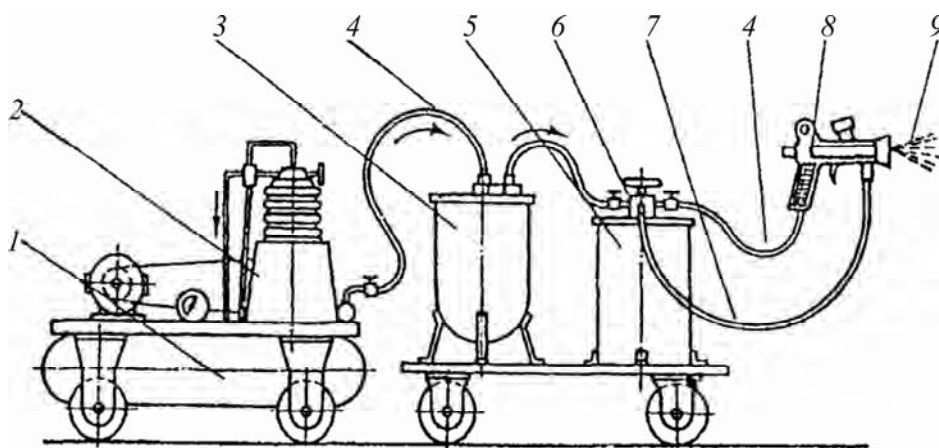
Схема компрессорного оштукатурочного агрегата, время высыхания оштукатурок, нанесенных на свежеложенные стяжки — от 12 до 14 ч: 1 — воздухохранилище; 2 — компрессор; 3 — маслоотделитель; 4 — воздушный шланг; 5 — краскопультный бак; 6 — редукционный вентиль; 7 — оштукатурочный шланг; 8 — краскораспылитель; 9 — факел
